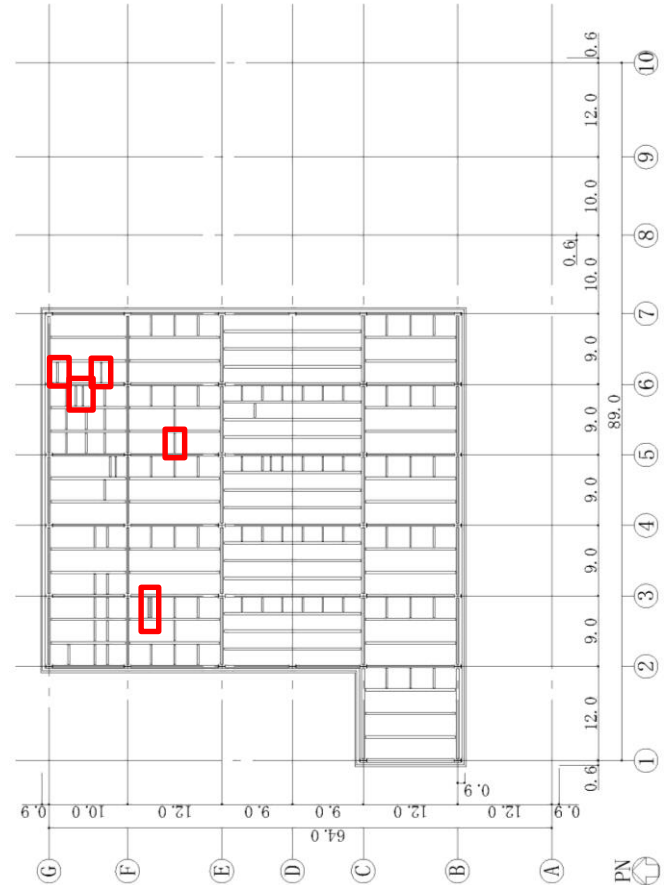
屋上階平面図 (G.L.+12.3) (単位 : m)
